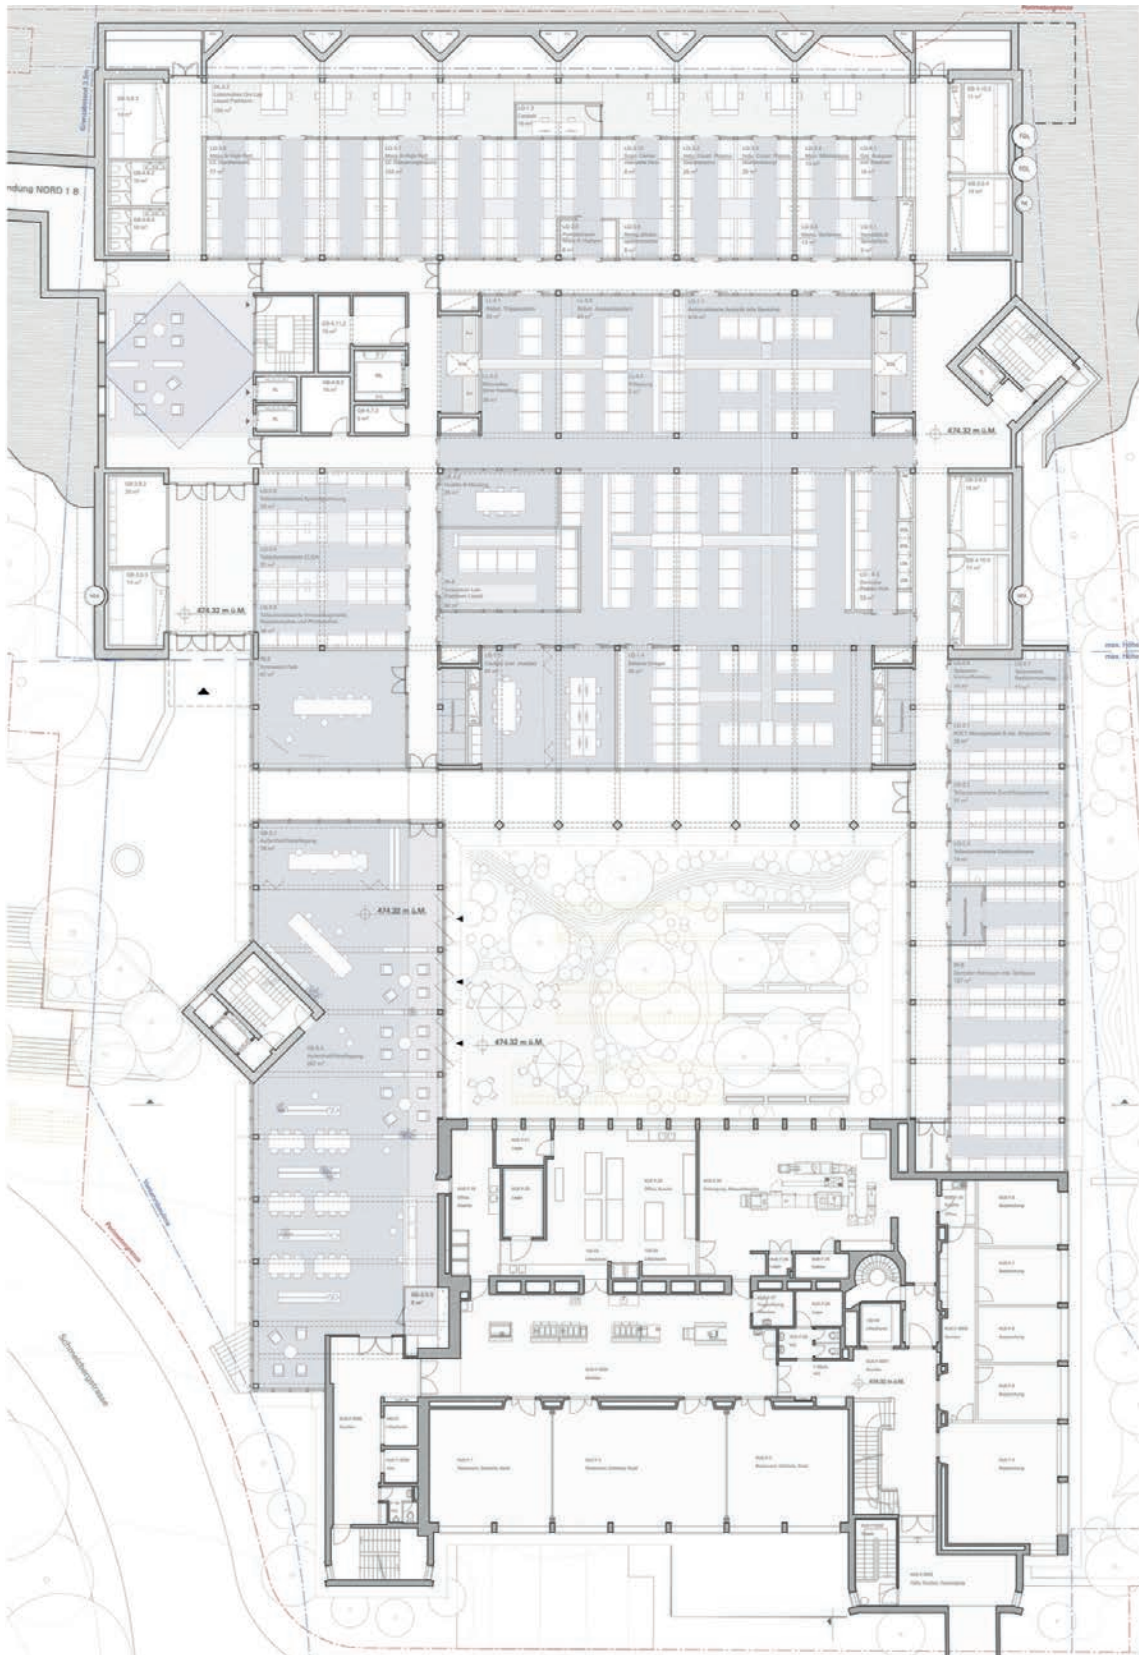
Boltshauer Architekten mit Mettler Landschaftsarchitekten: Grundriss Erdgeschoss
